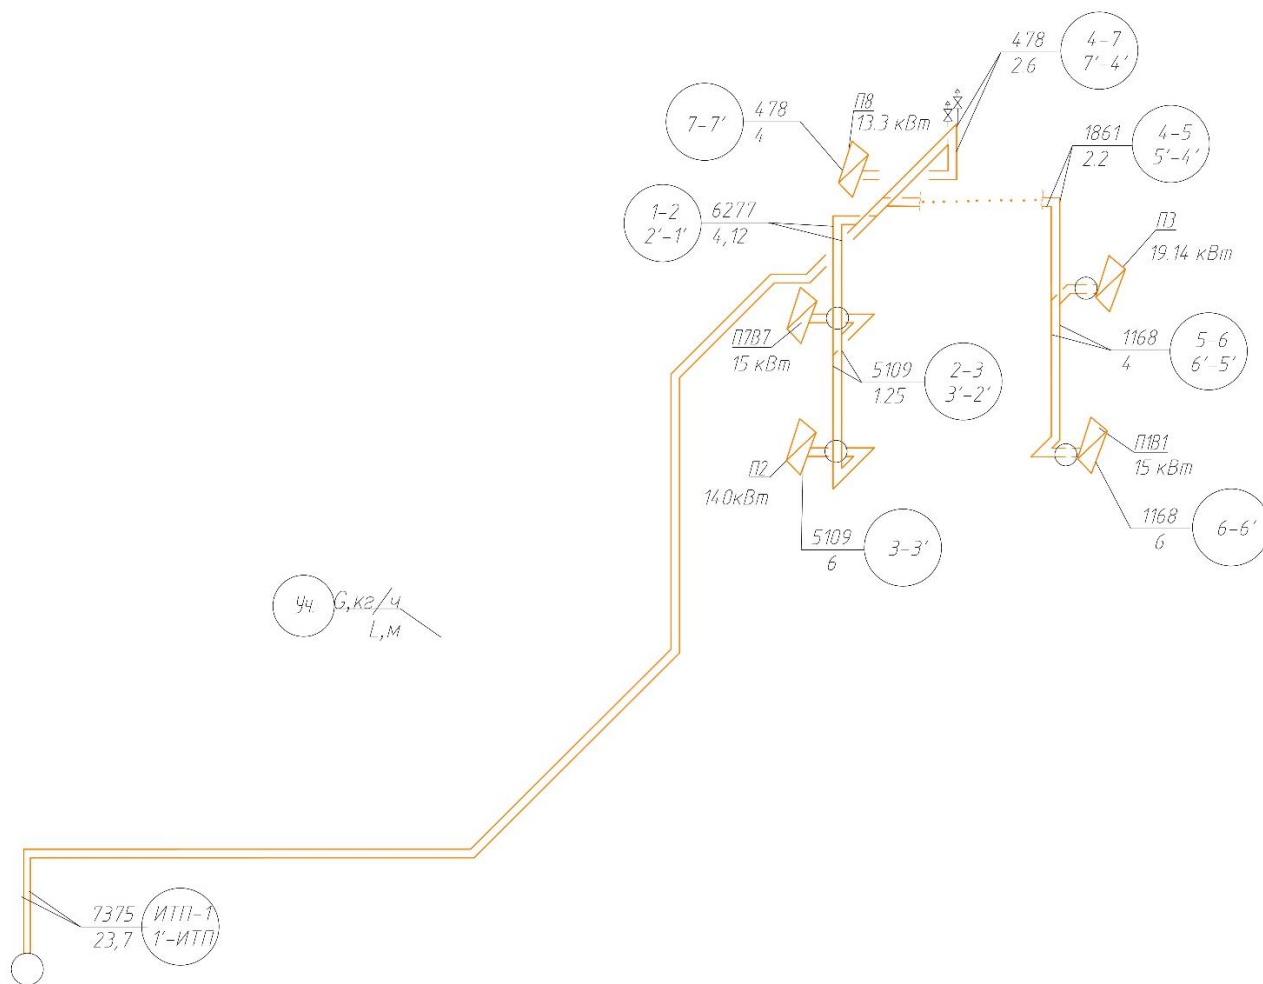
Расчетная схема системы теплоснабжения приточных установок
